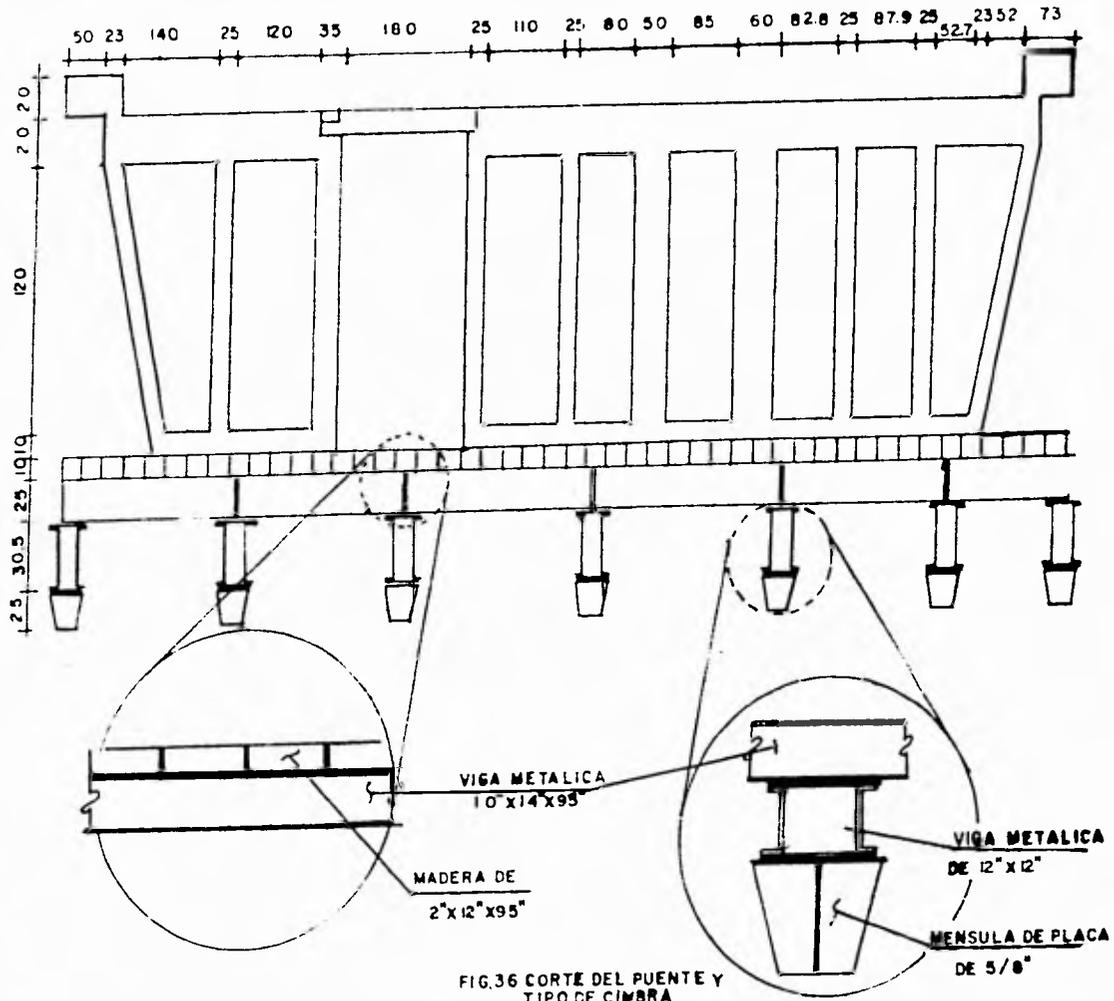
CORTE DEL PUENTE Y TIPO DE CIMBRA
